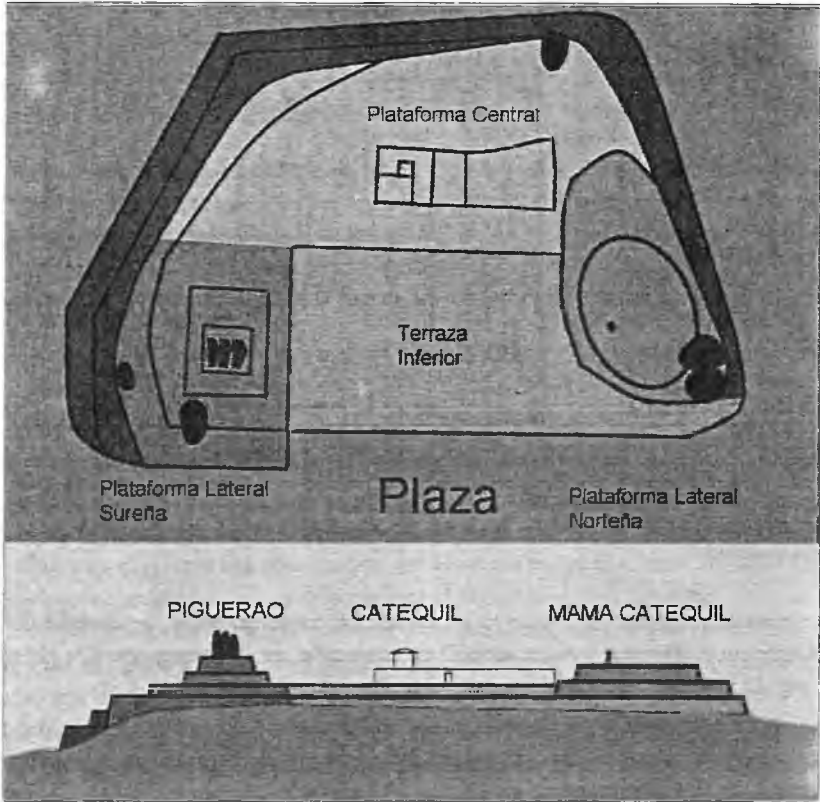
Reconstrucción del plano y la fachada del templo de Namanchugo. Los elementos en negro son piedras grandes.
